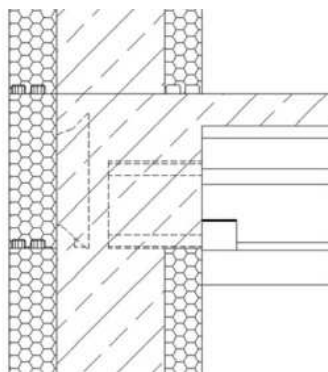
Parede e laje sem necessidade de camada de compensação (ARGISOL, 2010).
